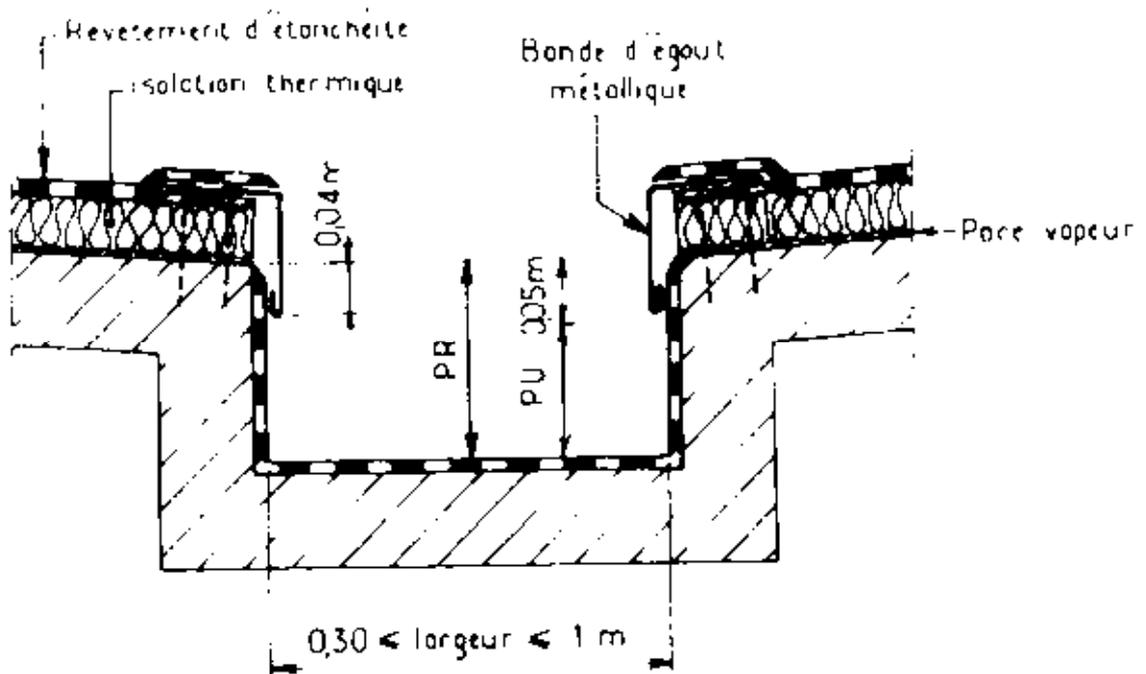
b Chéneaux/chéneau en encorbellement avec revêtement d'étanchéité continu
